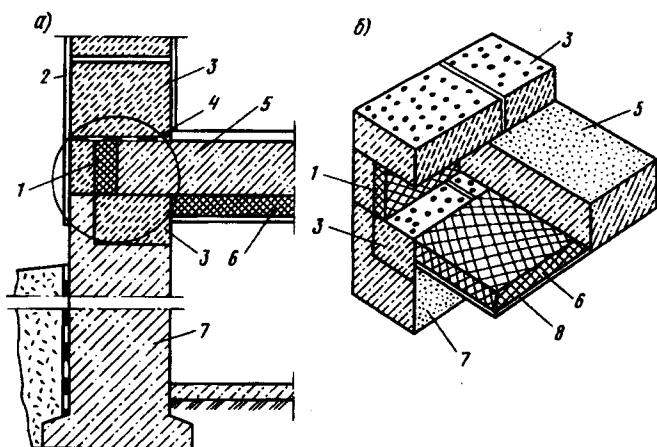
Утепление цокольного перекрытия над подвалом
